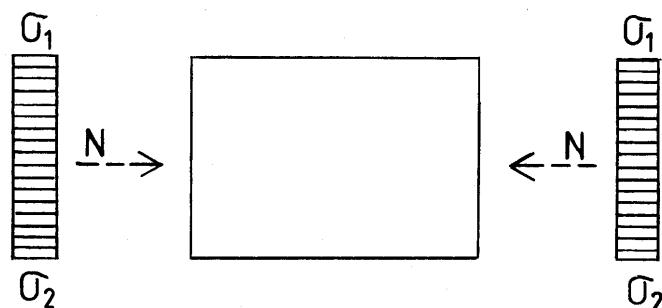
Namáhanie steny kombináciou tlaku a ohybu
